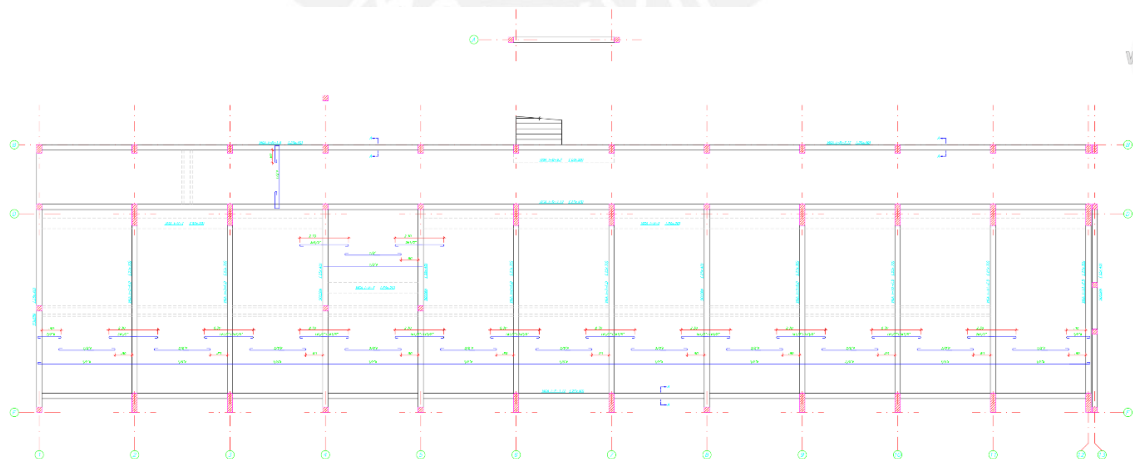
Plano de Encofrado del Primer piso del Pabellón A de Ingeniería de la PUCP
